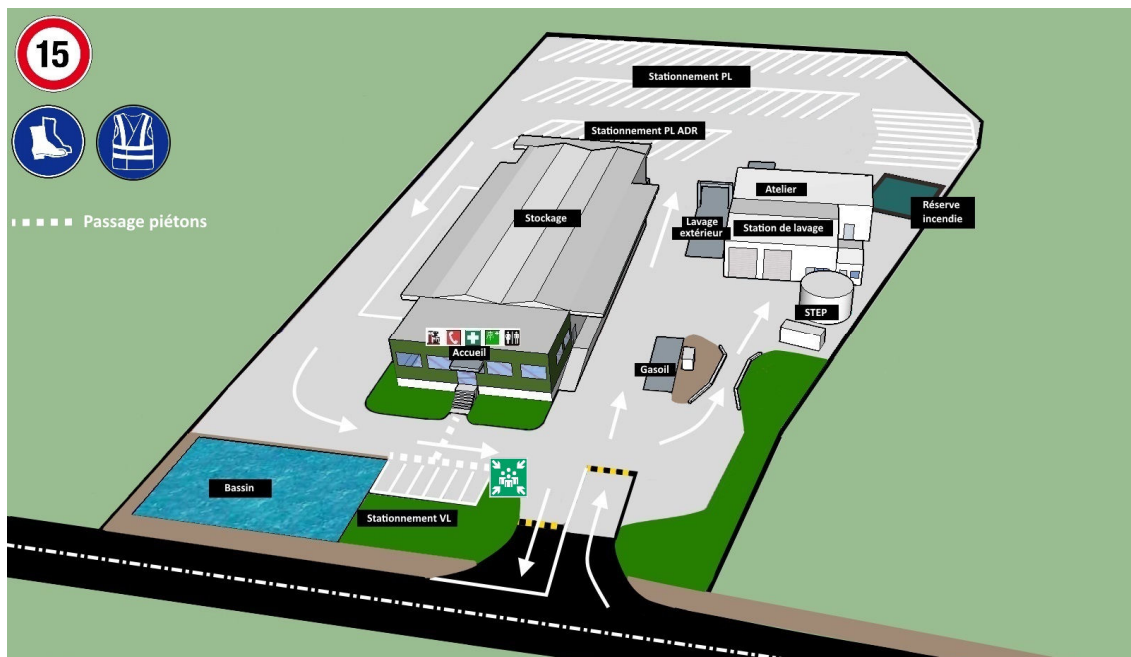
PLAN DE CIRCULATION PREVISIONNEL
